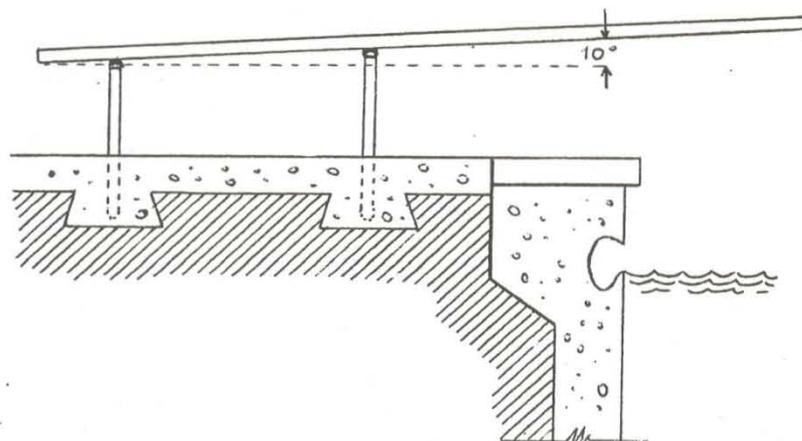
Sección de un trampolín instalado mediante pivotes empotrados en una losa de hormigón.
